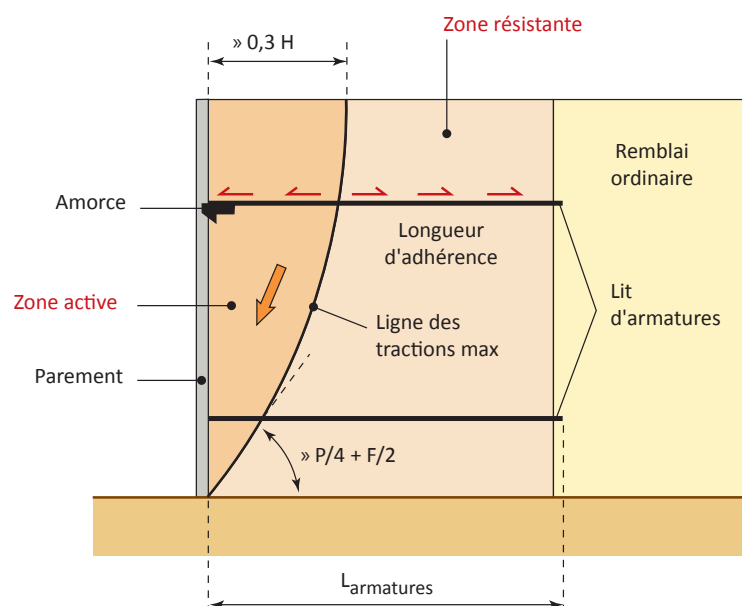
Stabilité interne d'un mur TA extrait du guide technique sur les ouvrages de soutènement (4)
